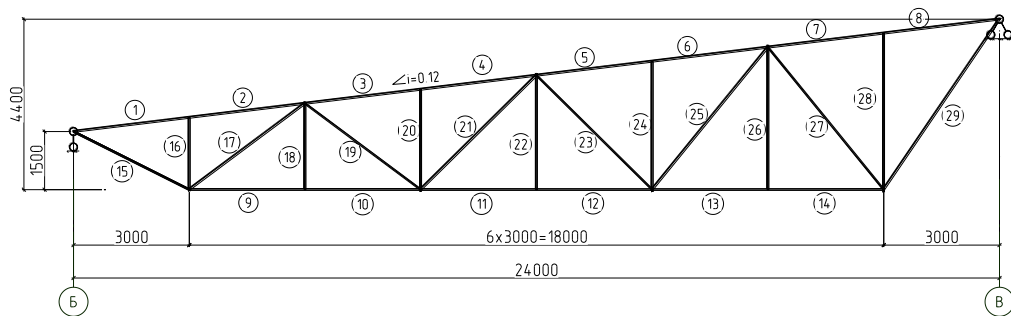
Расчетная схема фермы с номерами элементов
